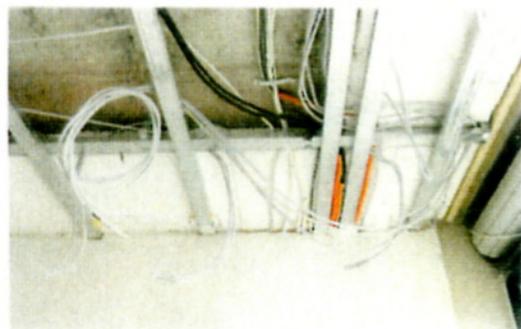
Auch die Anschlussbereiche zwischen Wand und Decke wurden mit Minerale Dämmplatten gedämmt.
